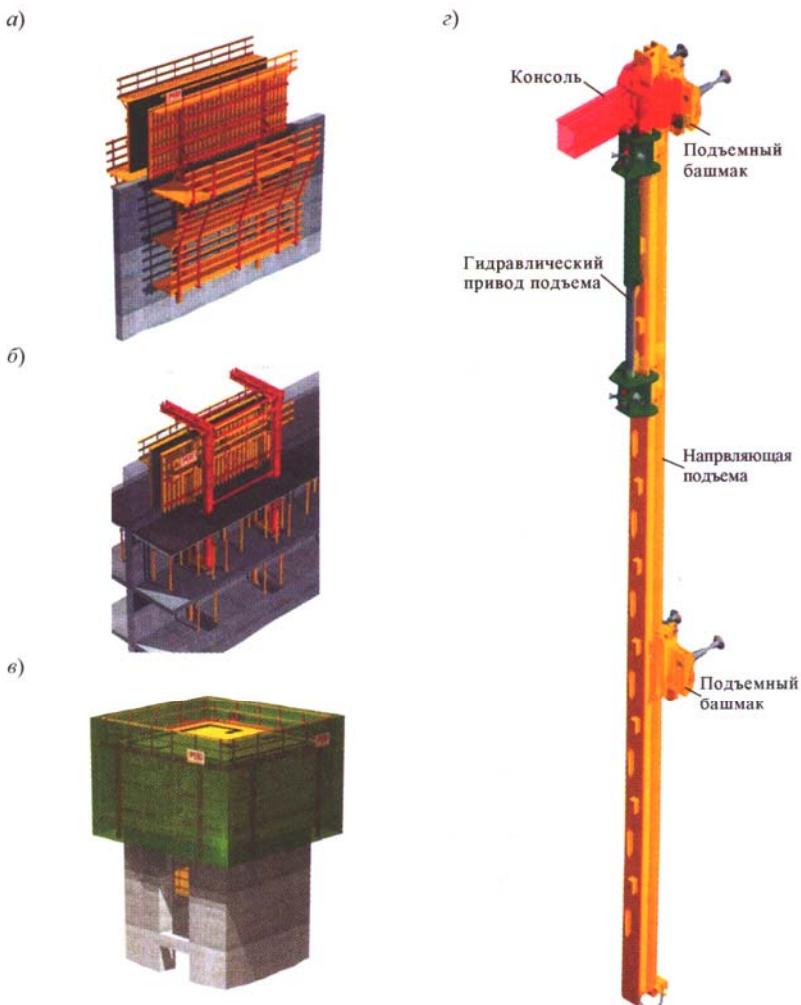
Подъемно-переставная опалубка: а - ACS-R для стен; б - ACS-G для круглых сооружений и бетонирования перекрытий и стен; в - ACS-P для сооружений сложного сечения; г - консольно-переставной блок
